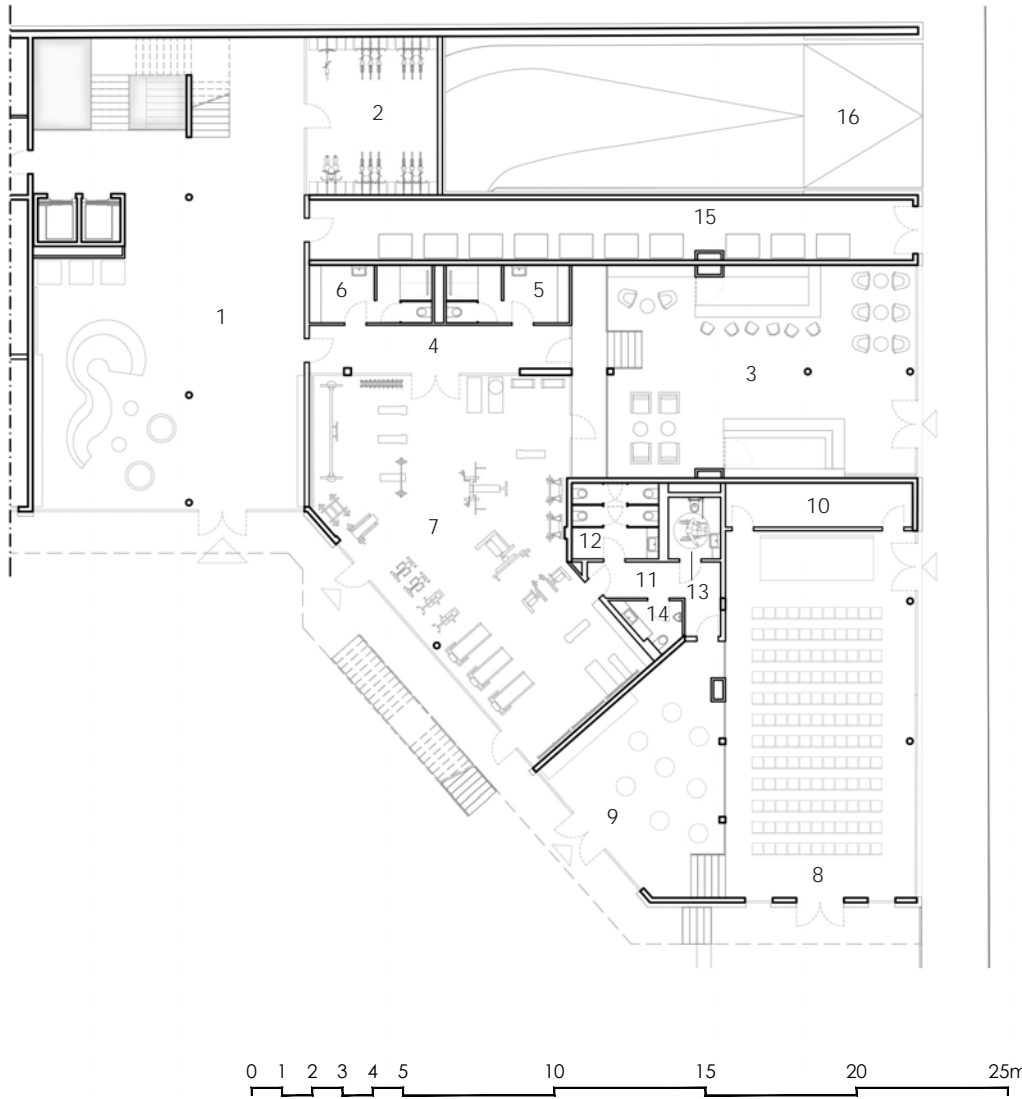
Grundriss Erdgeschoß - Bereich Fitnessstudio und Veranstaltung
